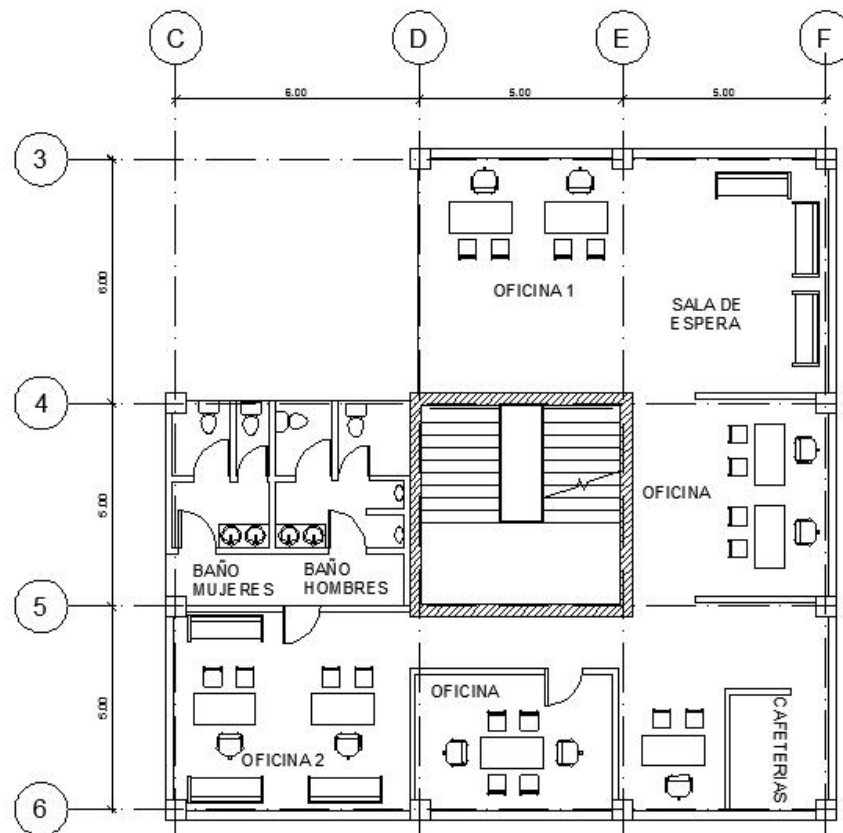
Planta tipo 2 Oficinas, Distribución arquitectónica
